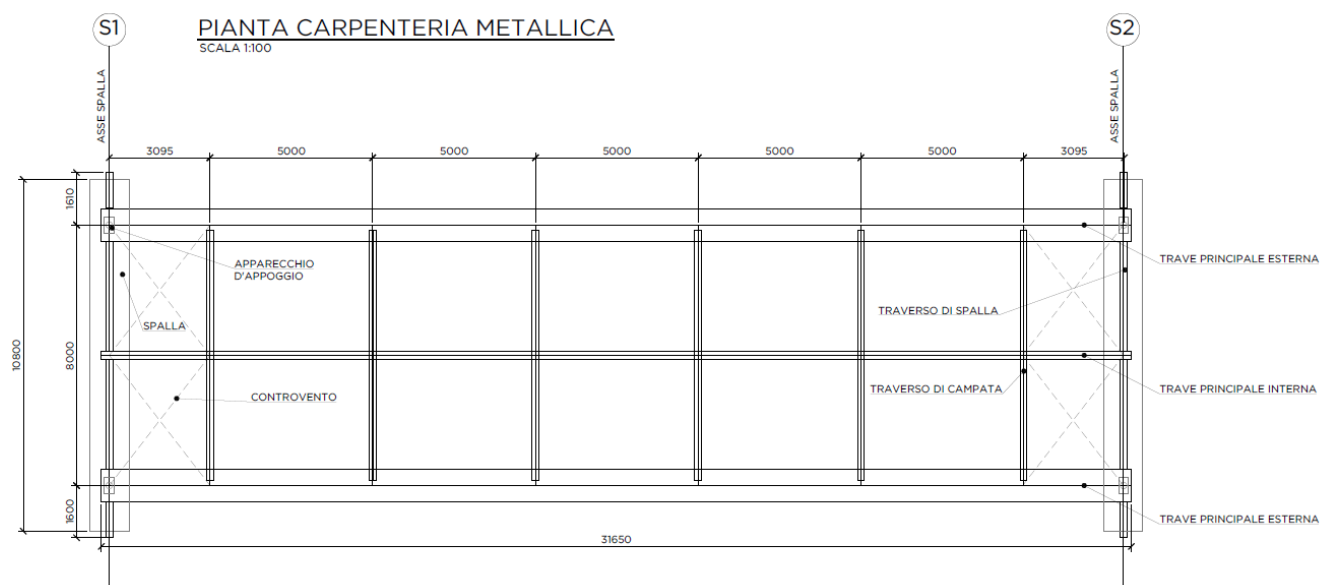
Proposta n°3 - Pianta carpenteria metallica
